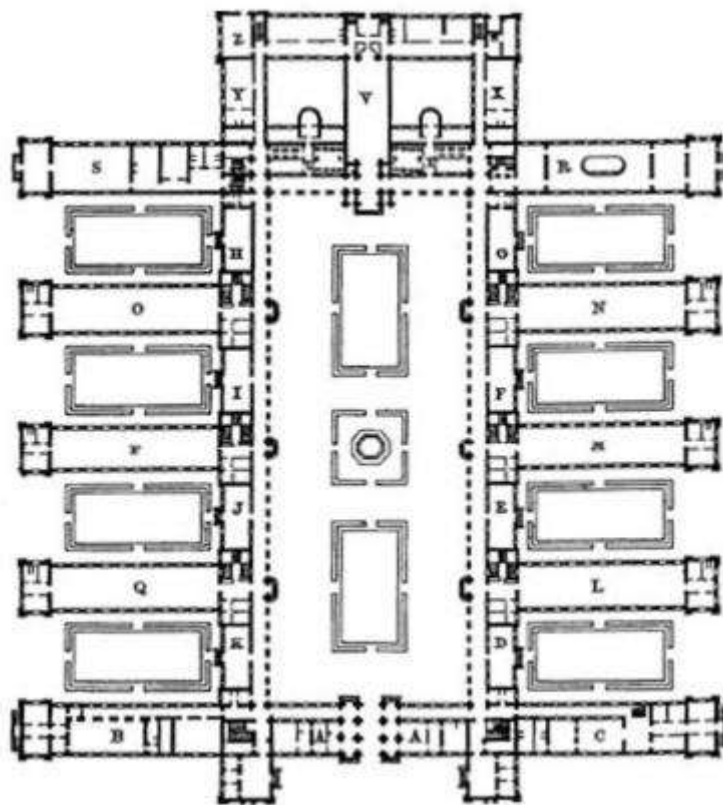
Hopital Lariboisiere, Parigi, 1846-54. Planimetria su progetto di M.P. Gauthier.
